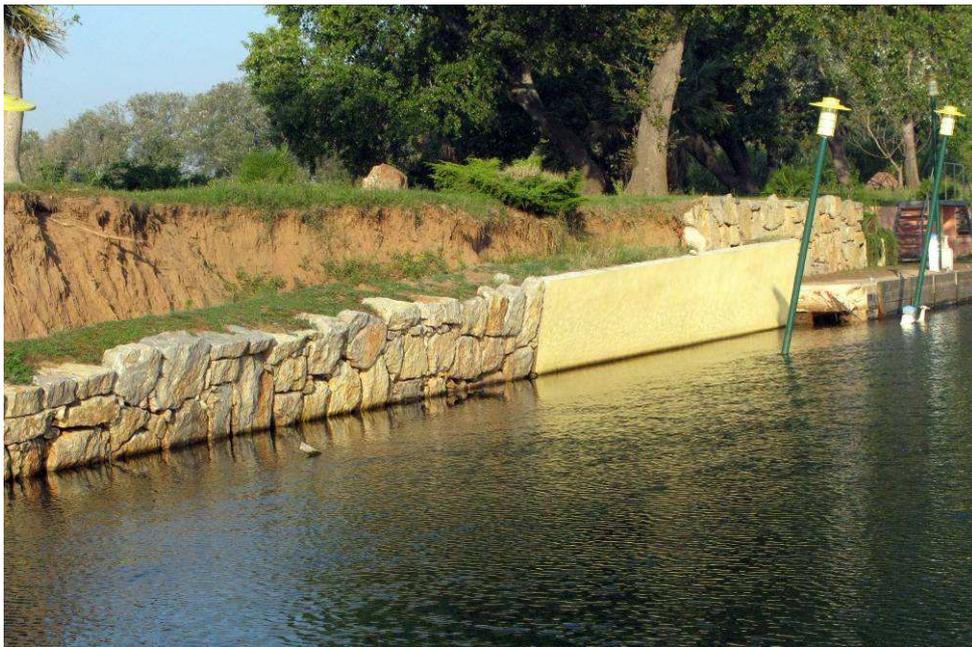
Effondrement du mur rive droite au PK 20 en juin 2010
